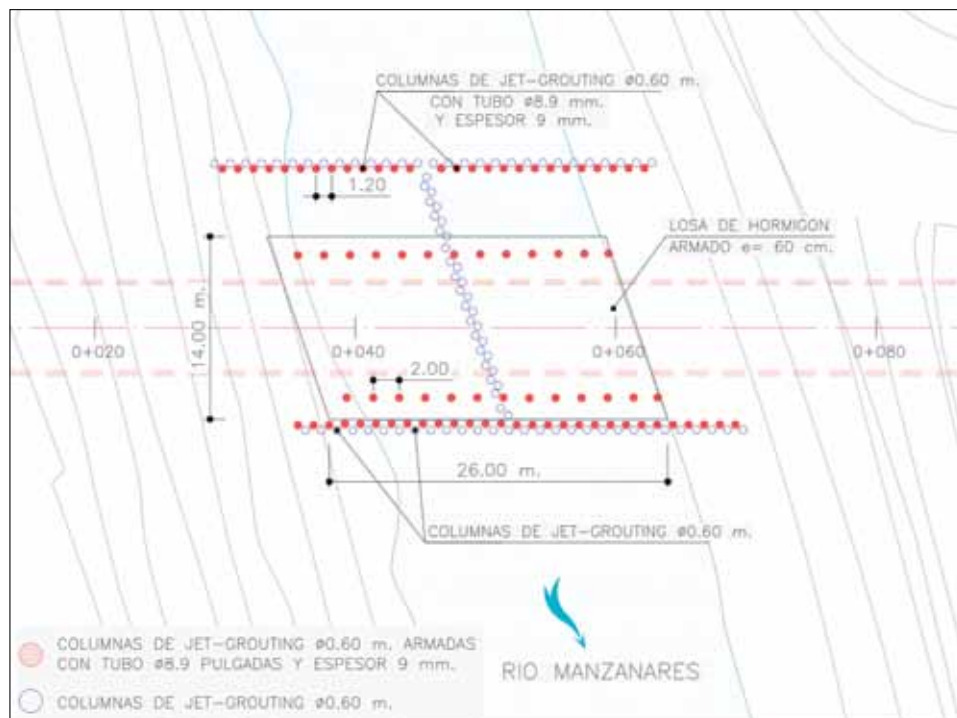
Cruce del río Manzanares y construcción de la losa superior de hormigón armado
